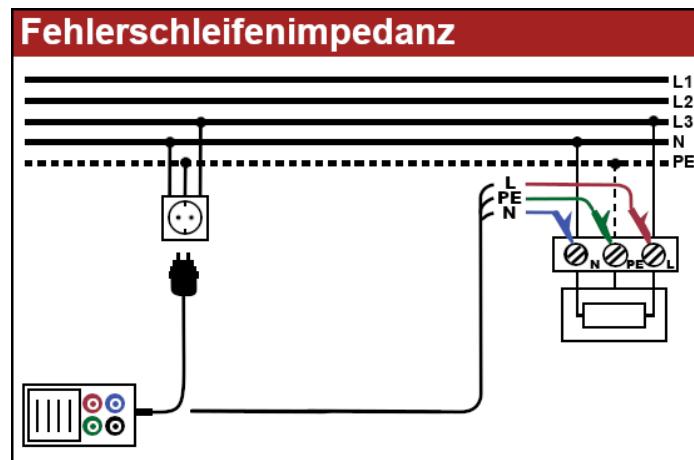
Verbindung von Steckerkabel und Universalprüfkabel
